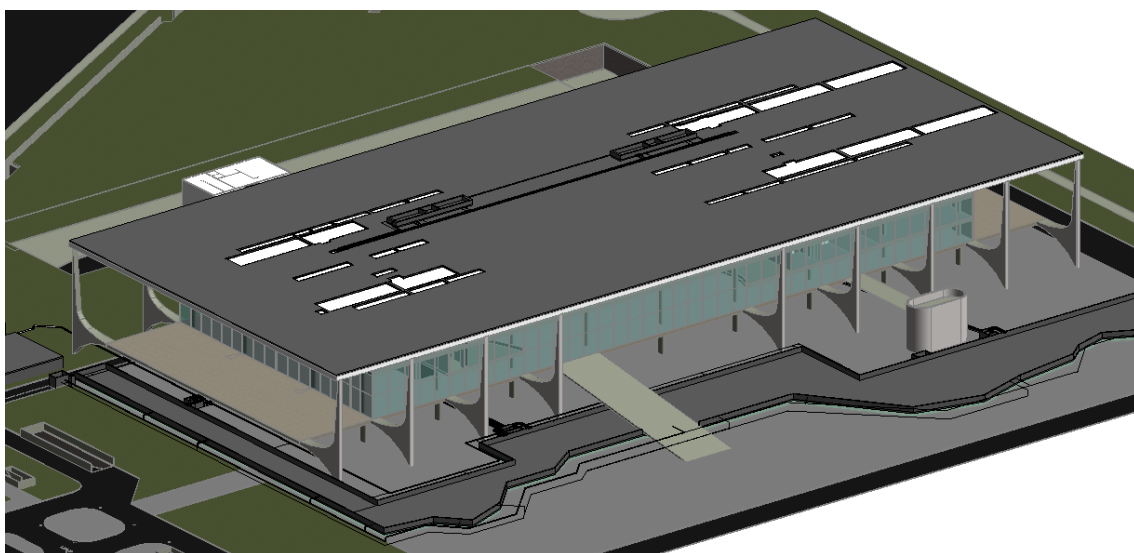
Compatibilização do projeto arquitetônico com o projeto de Cobertura do Palácio do Planalto. Fonte: Autor (2019).
